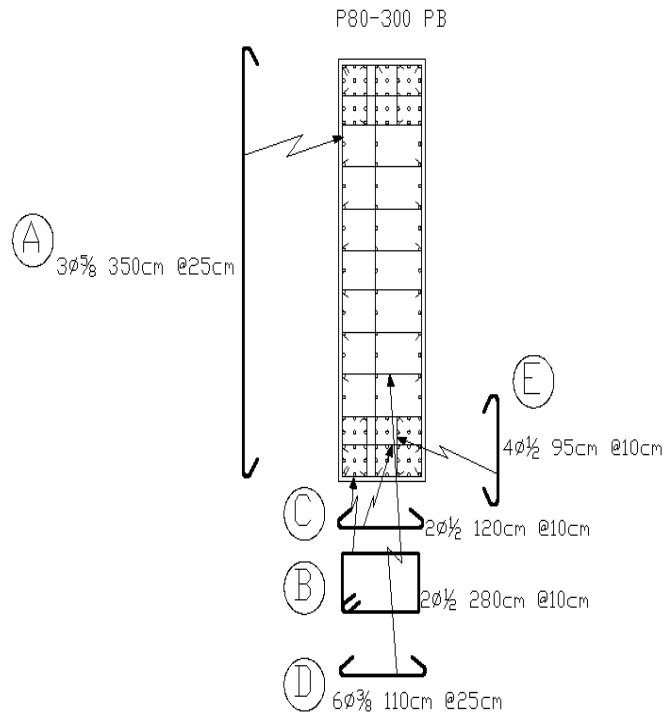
Armado de acero transversal de muro dirección X nivel PB (ver planos de detalles).
